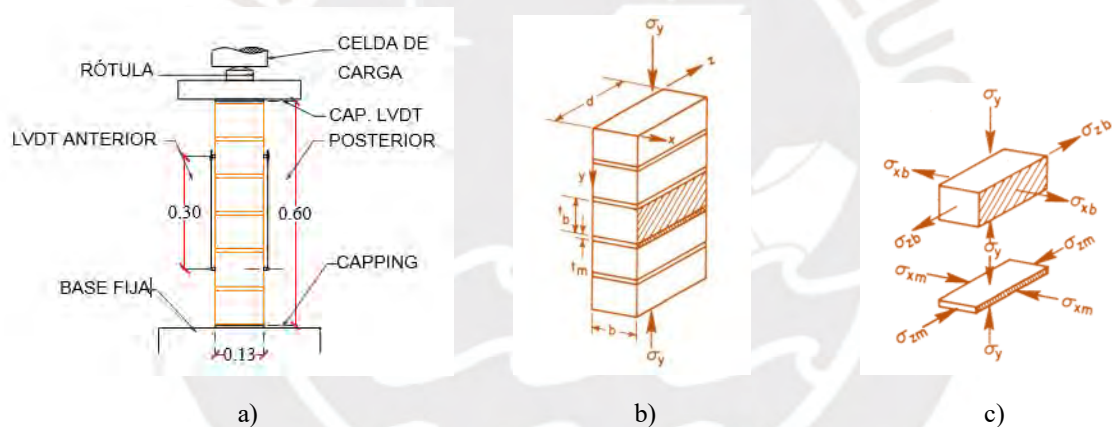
a) Instrumentación de ensayo de pilas, b) Pila de albañilería con carga axial, c) Estado de esfuerzos resultantes en la unidad y mortero [5].
